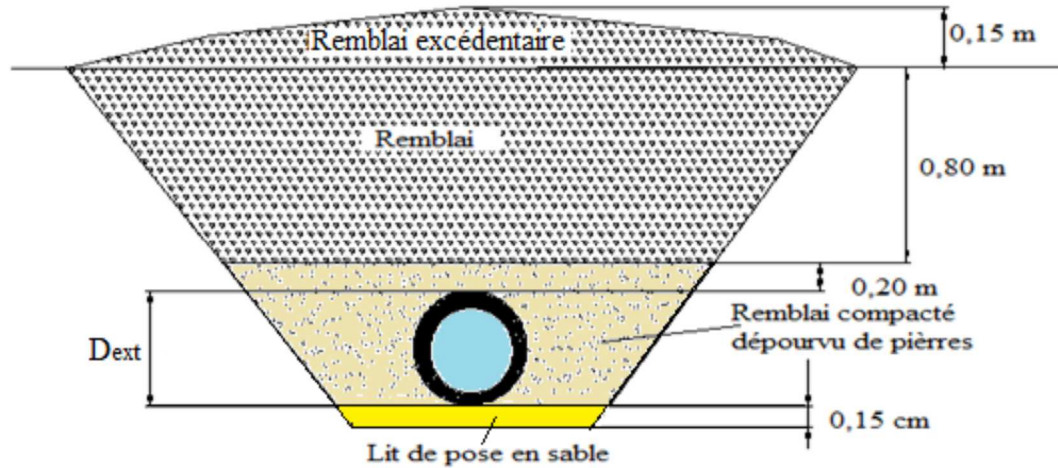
Coupe transversale d'une conduite enterrée.
